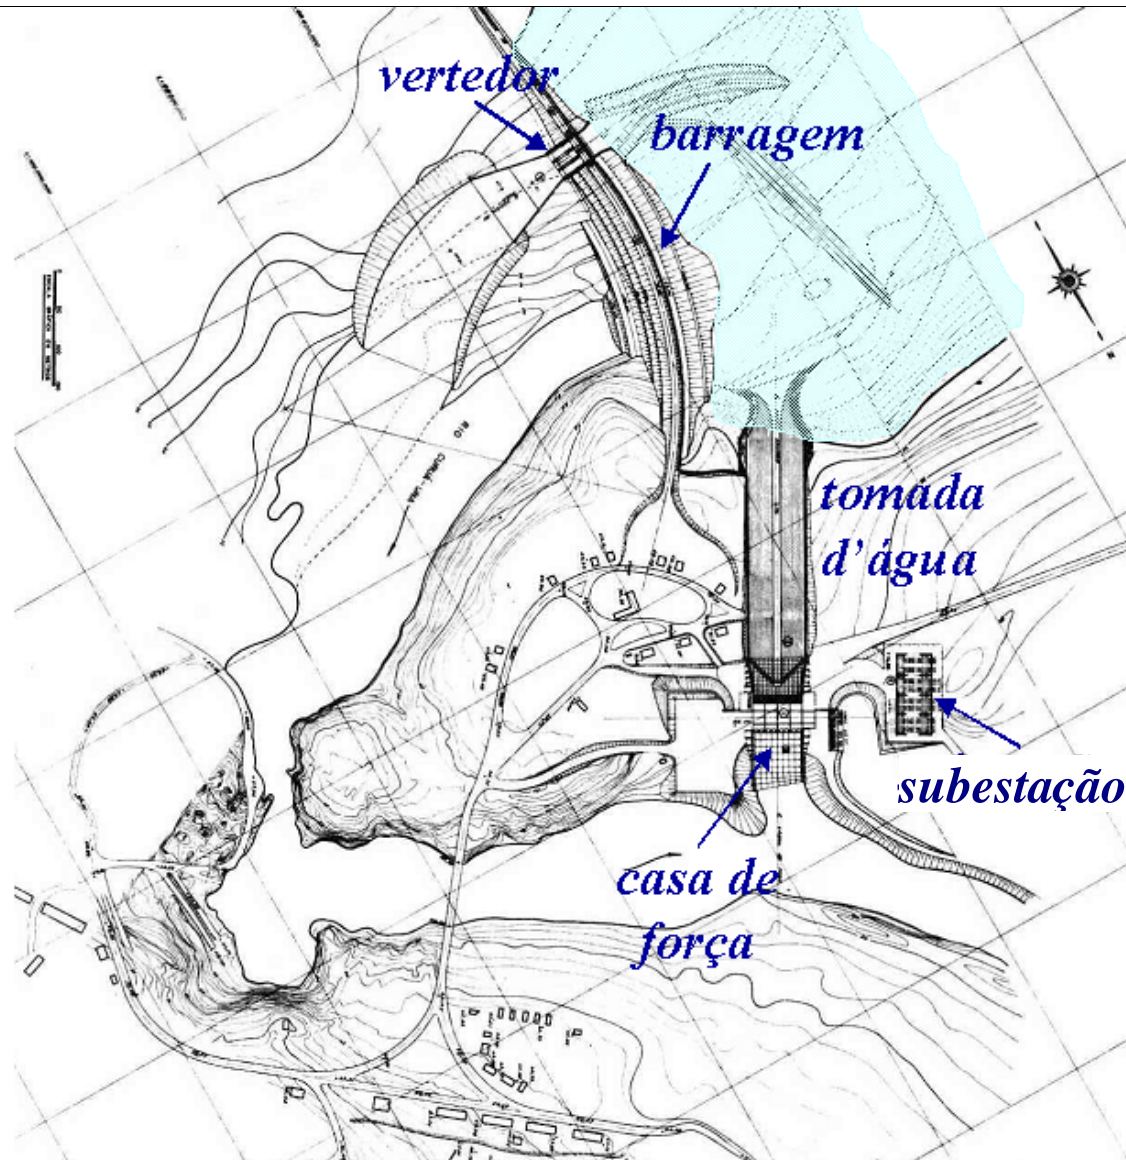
Planta esquemática da U.H.E. de Curuá-Una (Pierre et al, 1982)
